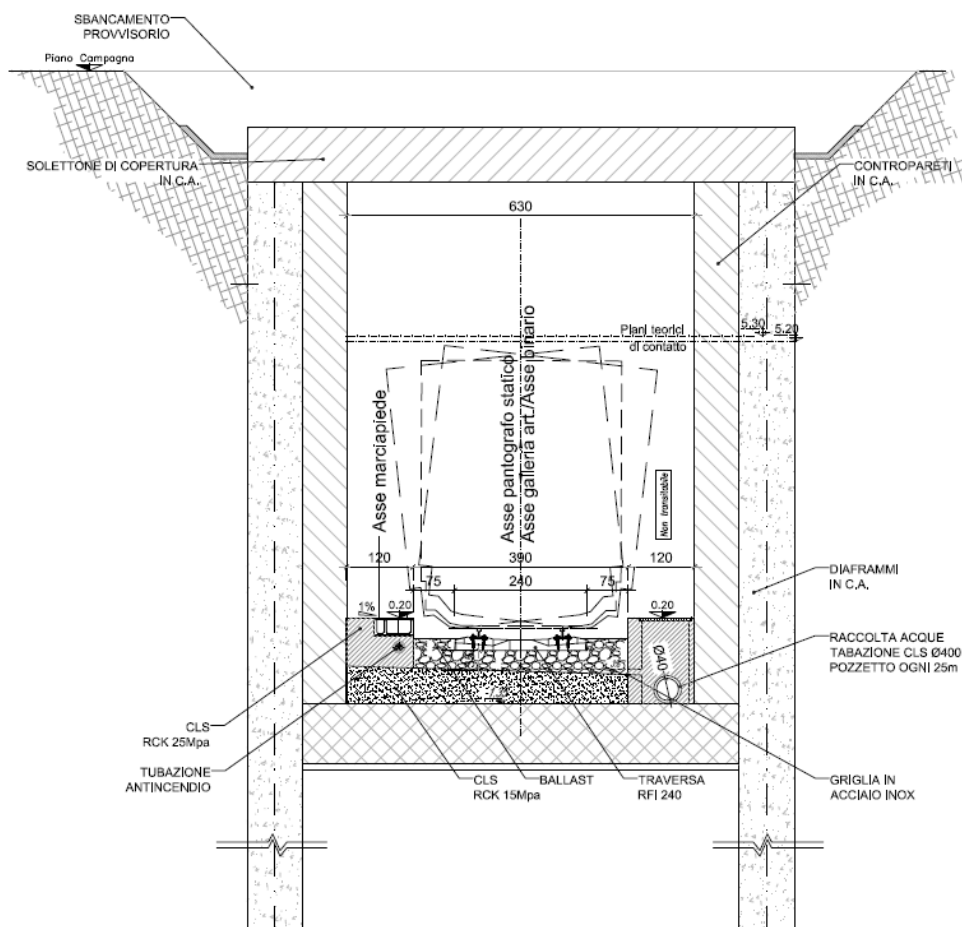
Sezione tipo Galleria artificiale (sezione tipo "2")
